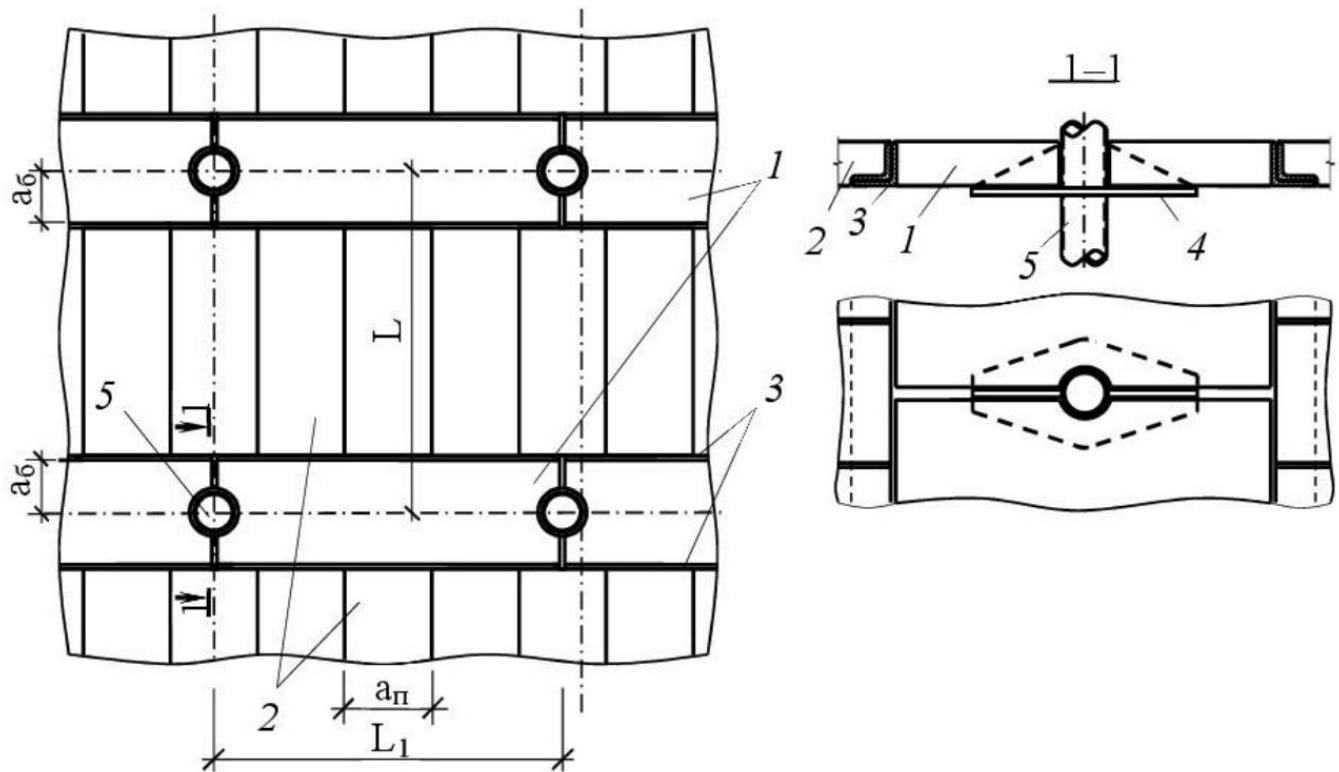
Фрагмент збірного сталезалізобетонного безбалкового перекриття: 1 – міжколонна плита; 2 – пролітна плита; 3 – сталеве обрамлення; 4 – сталевий диск; 5 – трубобетонна колона
